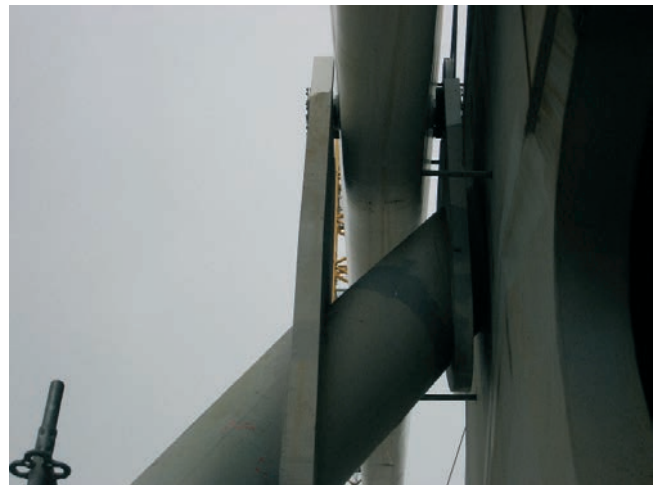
Chapas de espesor 60 mm ya soldadas a las orejetas del arco fijo y con el eje de giro de la costilla ya montado
